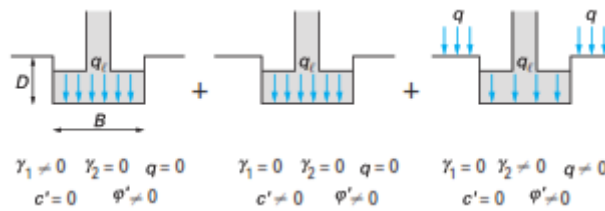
schéma de rupture d'une fondation superficielle. [5]
